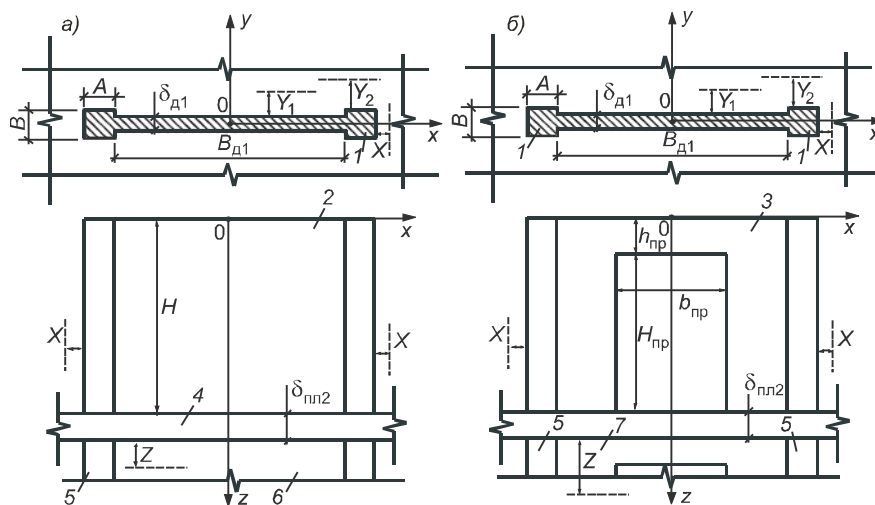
Расчетная схема бетонируемых колонн и примыкающей к ним монолитной диафрагмы глухой (а) и с проемом (б)
